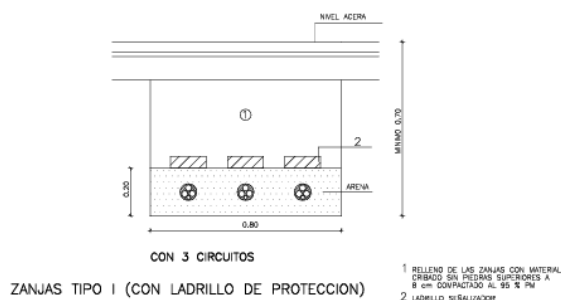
Sección zanjas de las instalaciones de telecomunicaciones. Fuente: Plano I-05 Proyecto de infraestructuras soterradas permanentes para el evento Carreras de Caballos en playa de Sanlúcar. Avenida de las Piletas, S/N, Sanlúcar de Bda (Cádiz).
